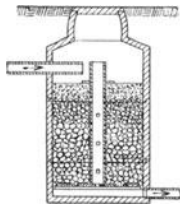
Klein-Tropfkörper mit zentraler Belüftung für Hauskläranlagen. (Nach W. Teschner)
